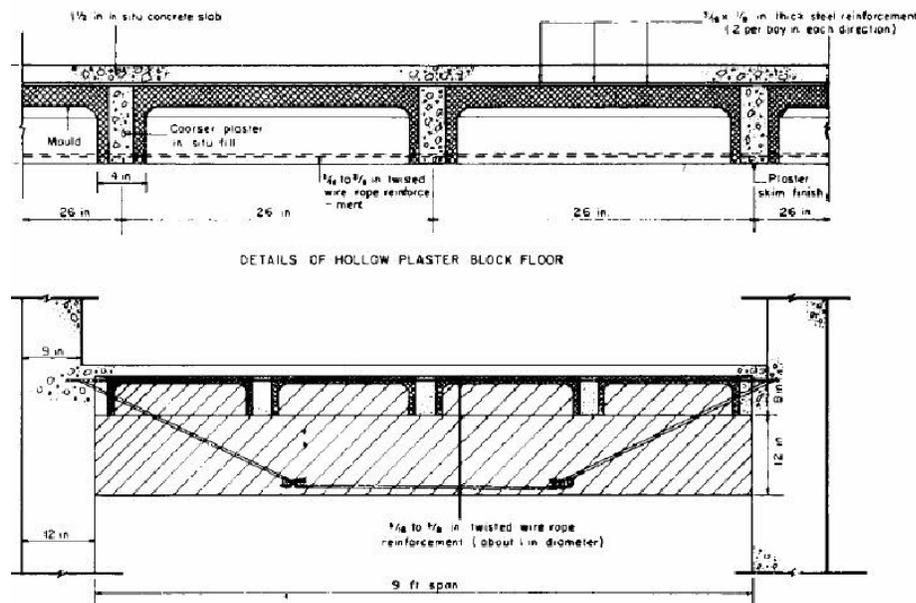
Patente do sistema de lajes nervuradas de Wilkinson. Fonte: LIMA *et al.* (2004).
